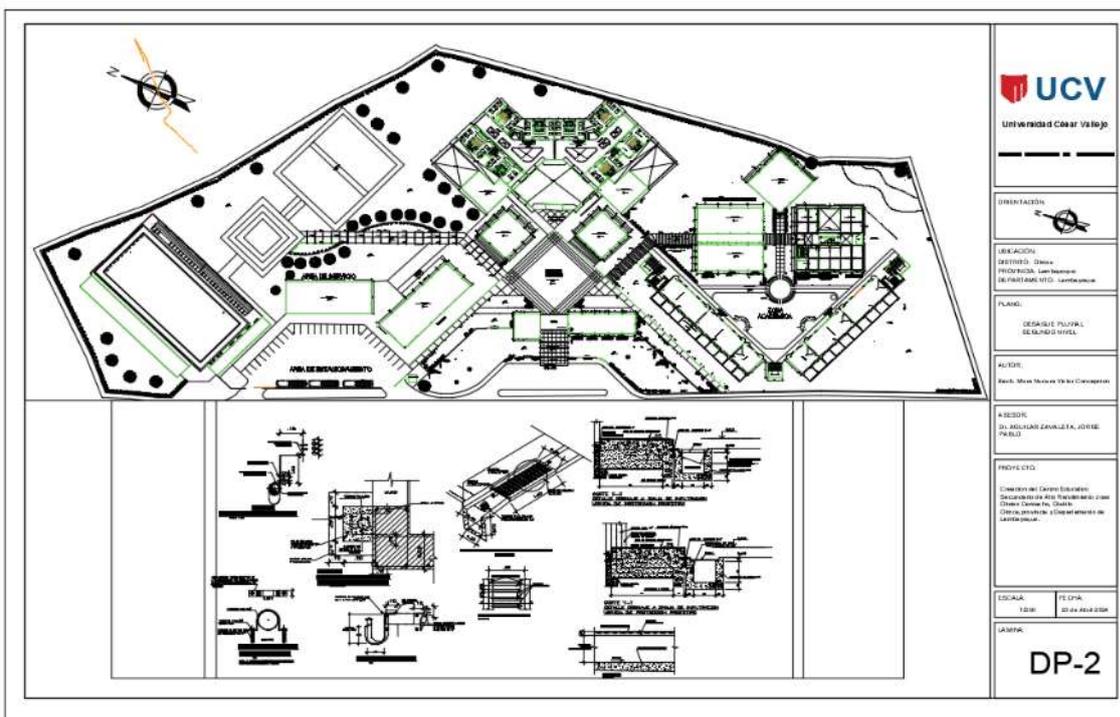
Plano De Desagüe Pluvial - Segundo Nivel
